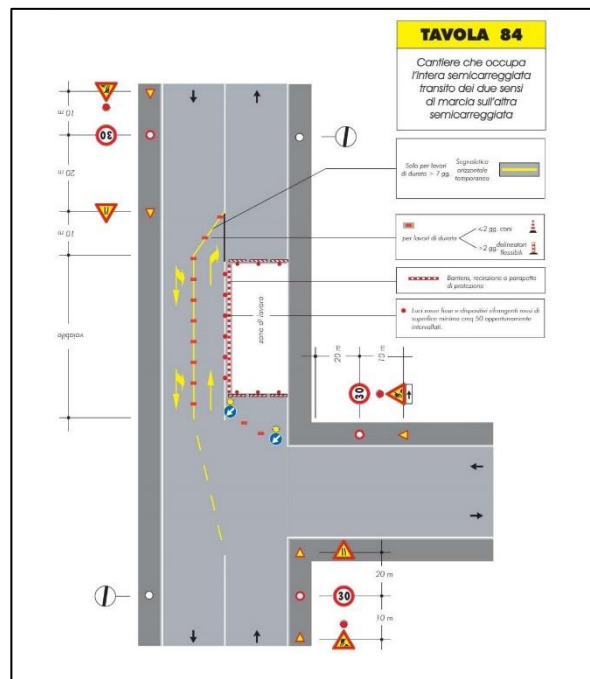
DOPPIO SENSO DI CIRCOLAZIONE RISTRETTO
